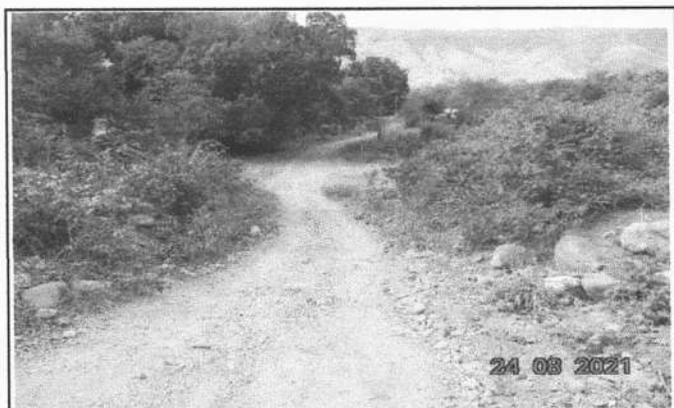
LOCAL DA CONSTRUÇÃO - BUEIRO
